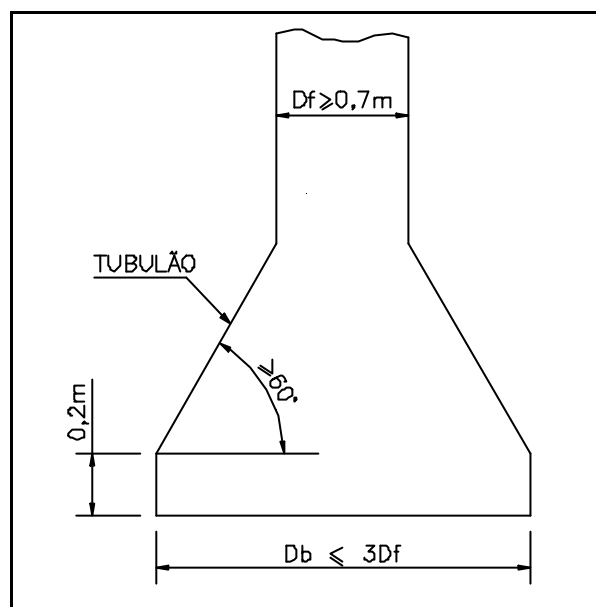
Detalhes construtivos de um tubulão, MELLO et al. (1993).
